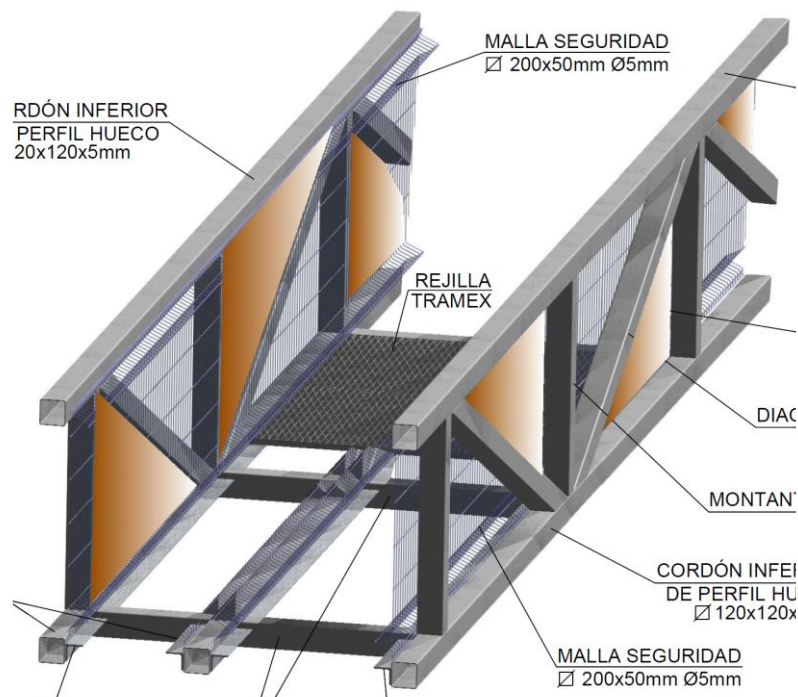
Detalle constructivo de las pasarelas - Cromatismo
